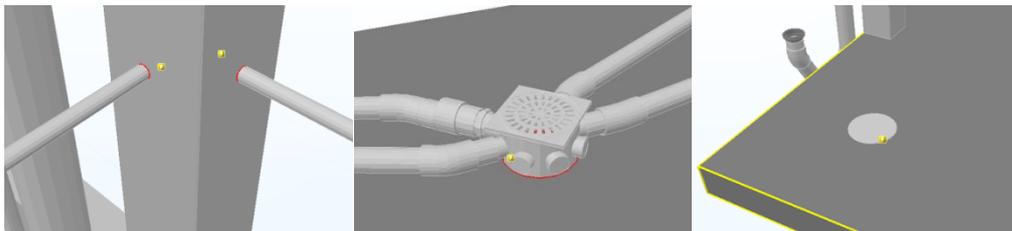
Duplicação de conflito e inserção de elemento MEP em laje.
